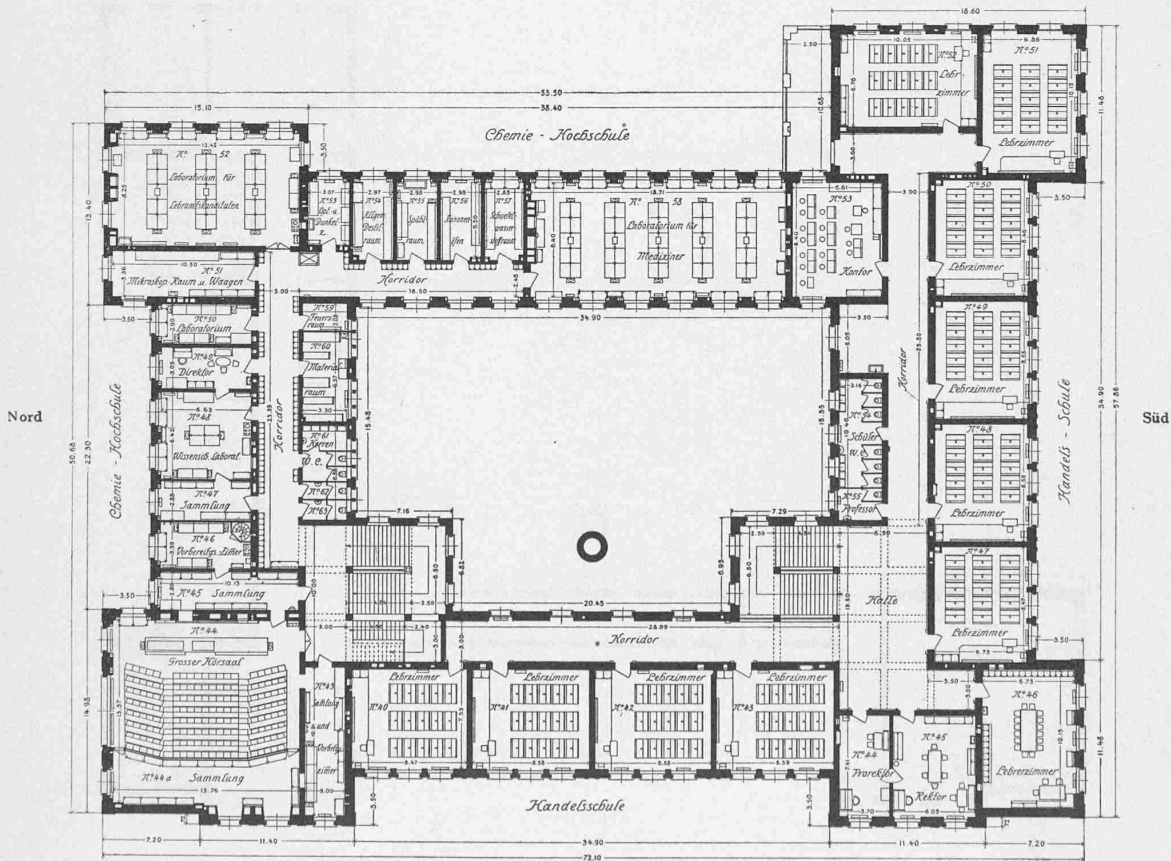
Grundriss vom I. Stock. — Masstab 1 : 500.
